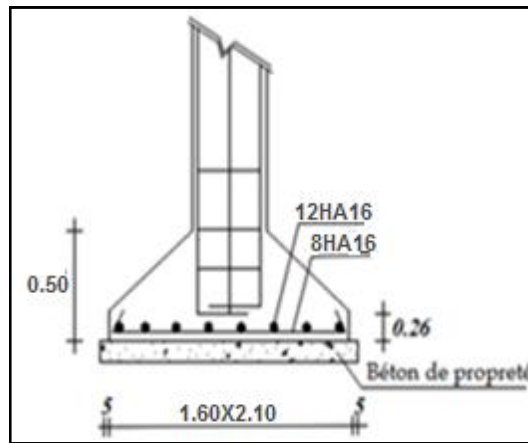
Exemple de ferrailage d'une semelle intermédiaire sous poteau
